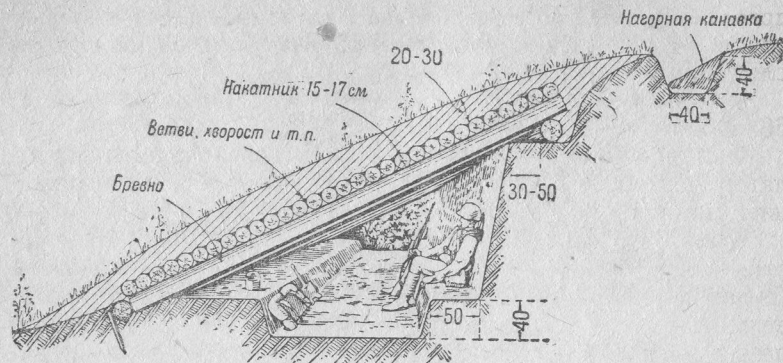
Заслон для бойцов с лёгким перекрытием.
